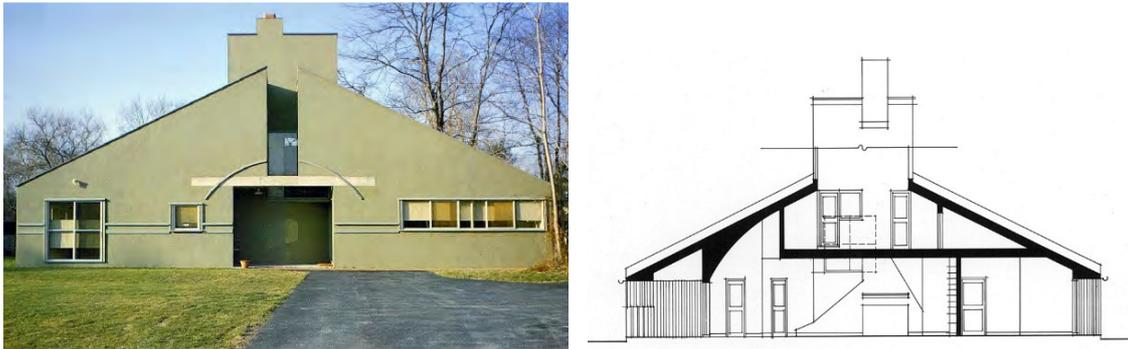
e 13 | Fachada da Vanna Venturi House [archdaily.com] e corte transversal [dezeen.com]
